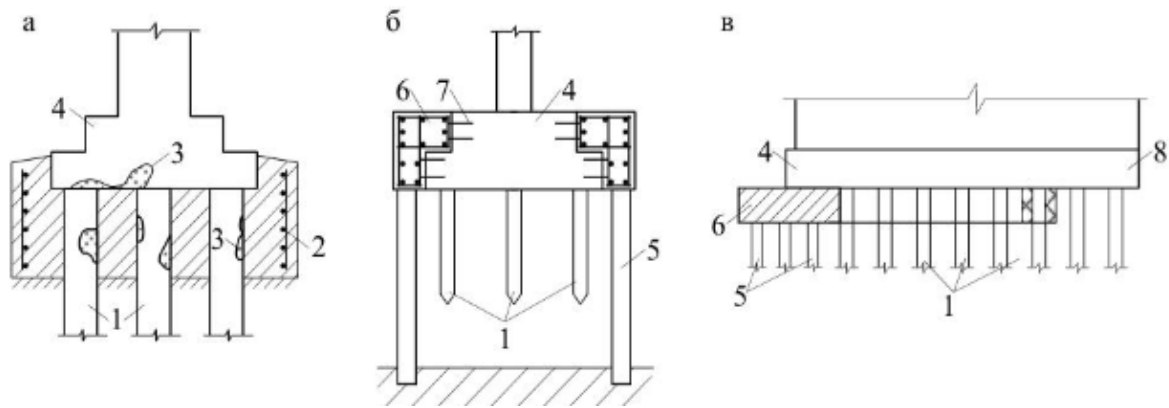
Підсилення пальових фундаментів: а – обмонолічуванням оголовків паль; б – влаштуванням виносних паль; в – підведенням додаткових паль; 1 – існуючі палі; 2 – залізобетонна обойма; 3 – пошкодження у палі та ростверку; 4 – ростверк; 5 – додаткова виносна паля; 6 – новий ростверк; 7 – зв’язки додаткового ростверку з тим, що підсилюється; 8 – сторона будівлі, по якій вирубувались палі
